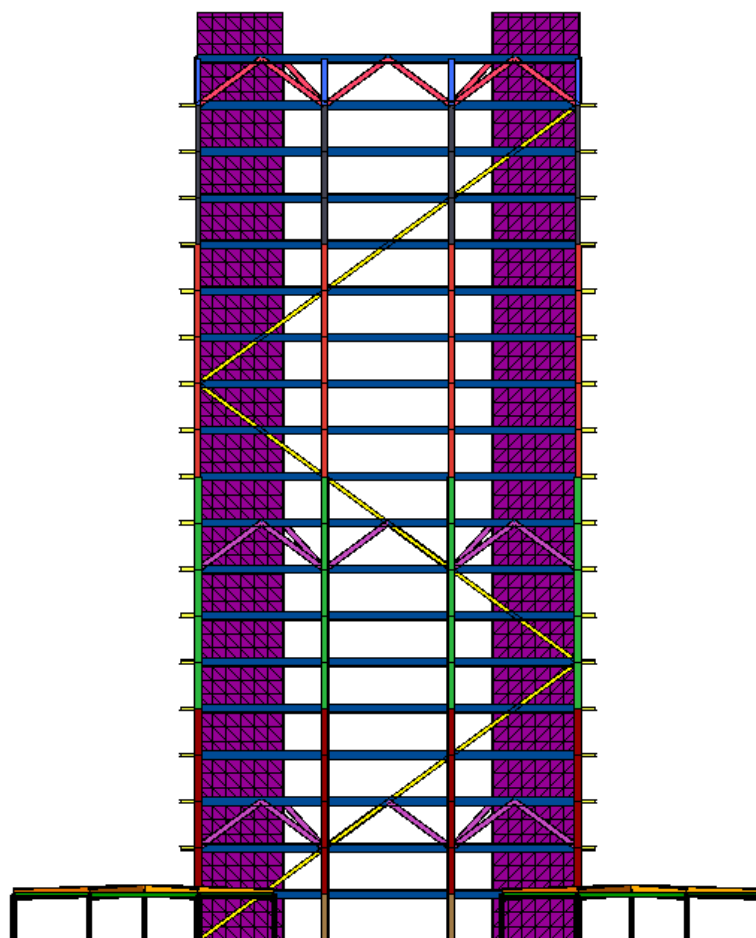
Расчетная схема 3D (поперечный разрез)
